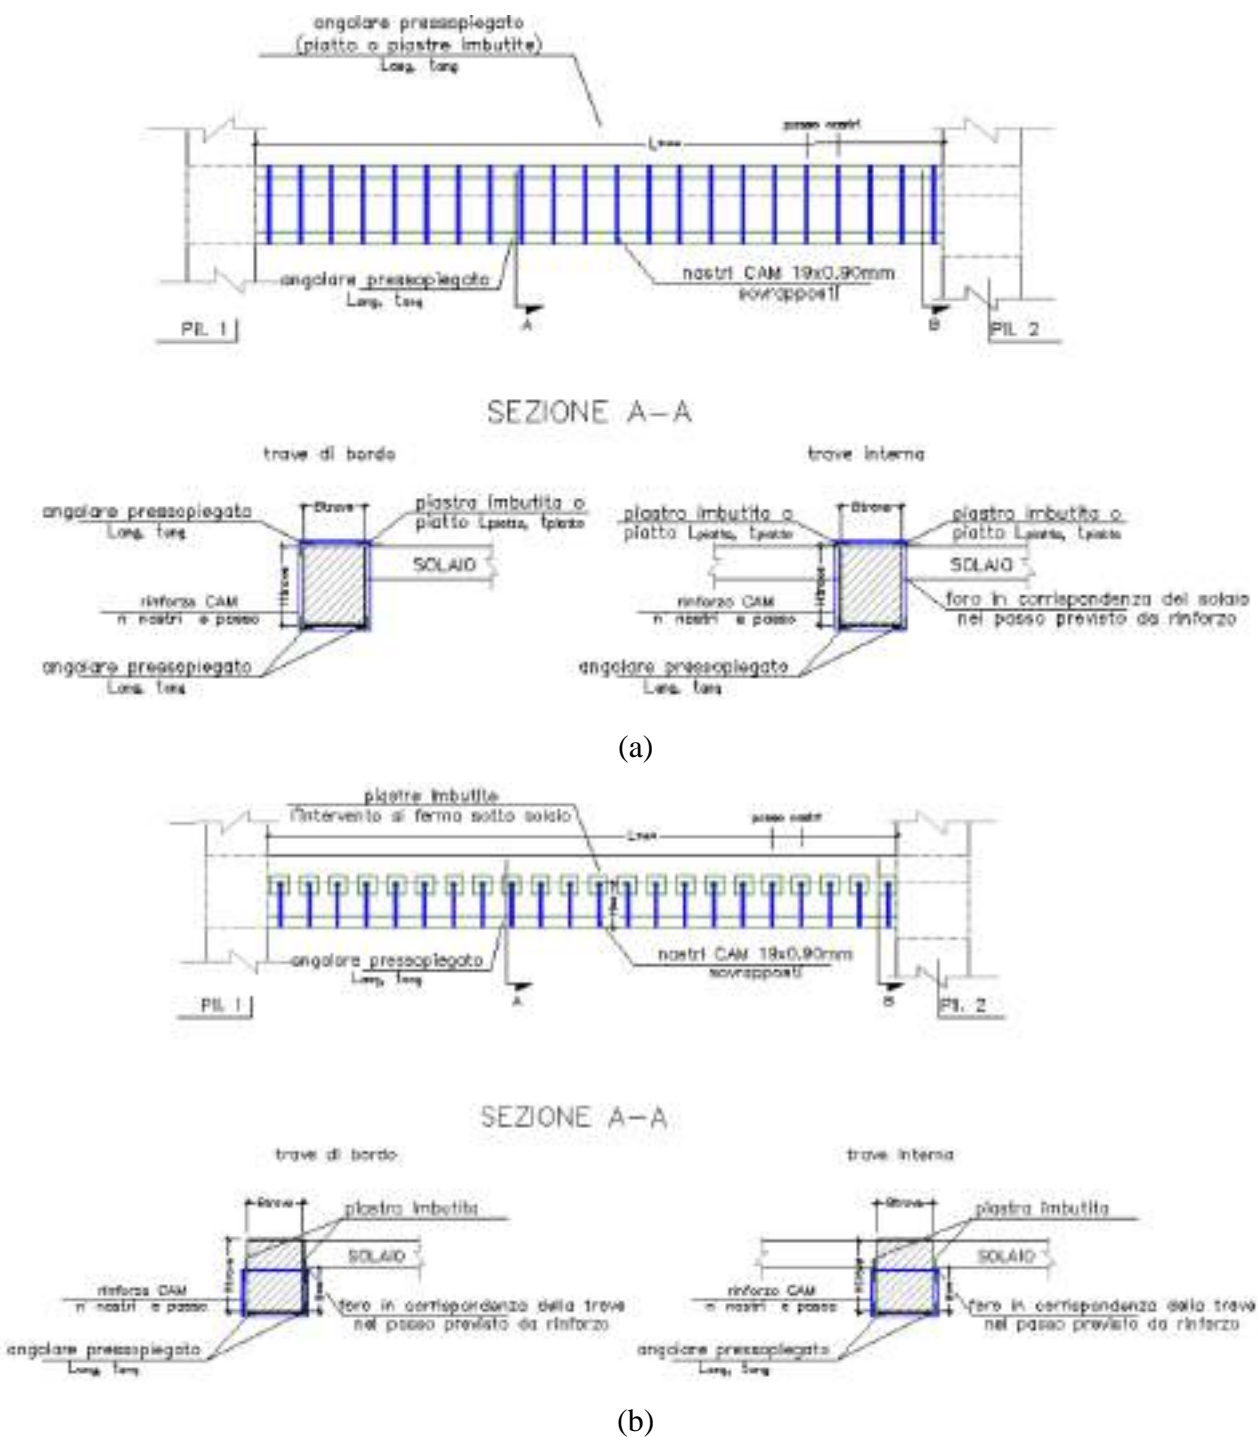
Schema di rinforzo trave con nastri CAM che (a) attraversano il solaio e (b) non attraversano il solaio
